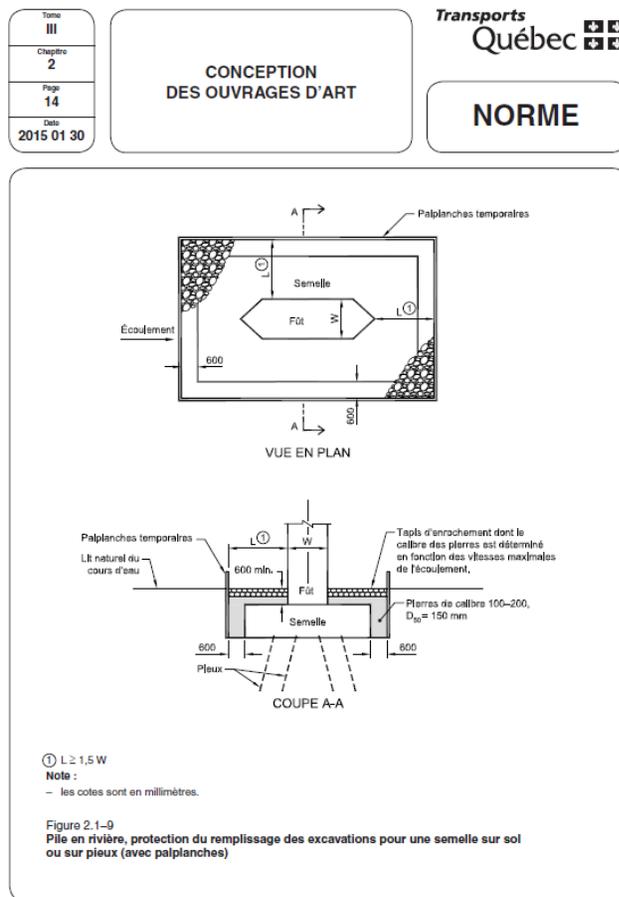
Schéma d’enrochement des semelles confiné à l’intérieur des batardeaux prévu autour des semelles des piles 4, 5, 7, 8, 9, 10 et 11 du pont Charles-De Gaulle (Collections Normes - Ouvrages routiers du MTQ, Tome III – Ouvrages d’art, Chapitre 2 - Conception des ouvrages d’art, p.14)
